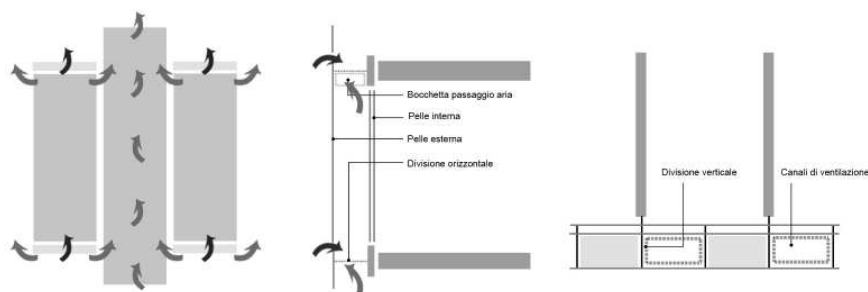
Sistema di ventilazione nelle "shaft box facades"
